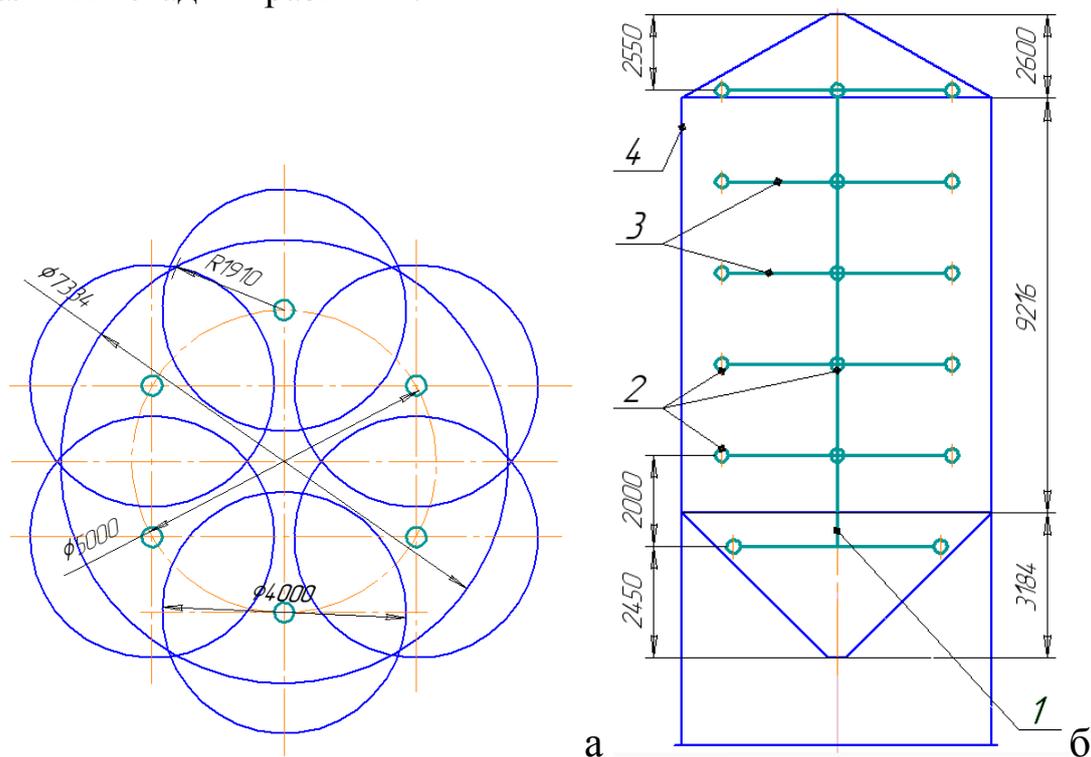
Схематичное размещение воздухопроводов в силосе: а – одного яруса воздухопроводов; б – уровней воздухопроводов по высоте силоса 1 – центральный трубопровод; 2 – воздухопроводы; 3 – отводящие трубопроводы; 4 – силос.
